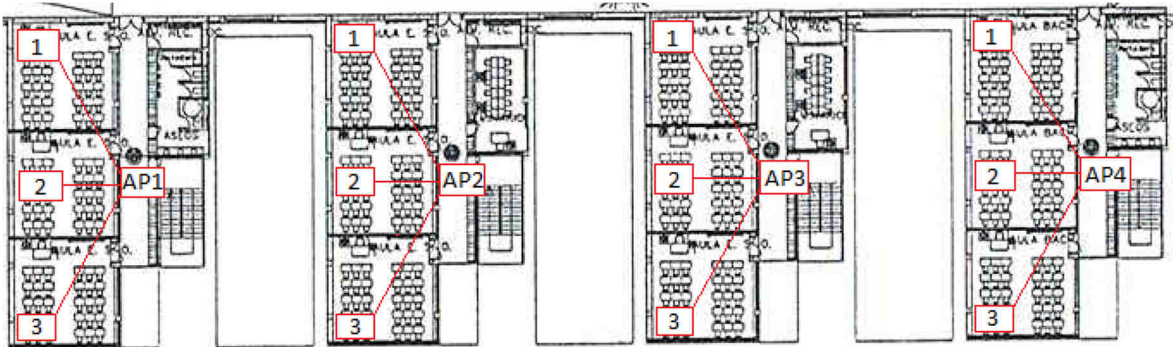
APs 1, 2, 3 y 4 planta segunda
